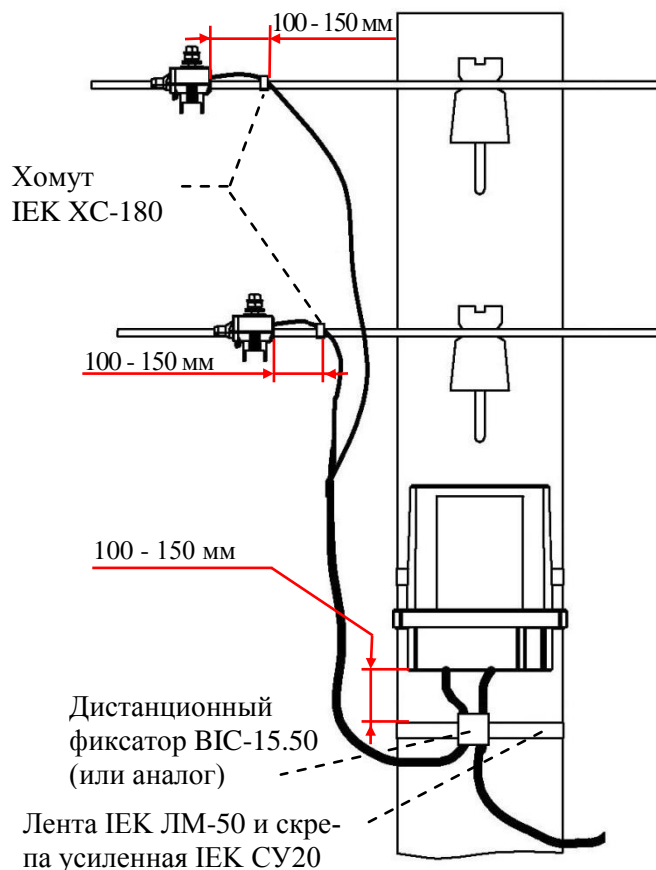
Крепление провода при установке счетчика на опору линии электропередачи
